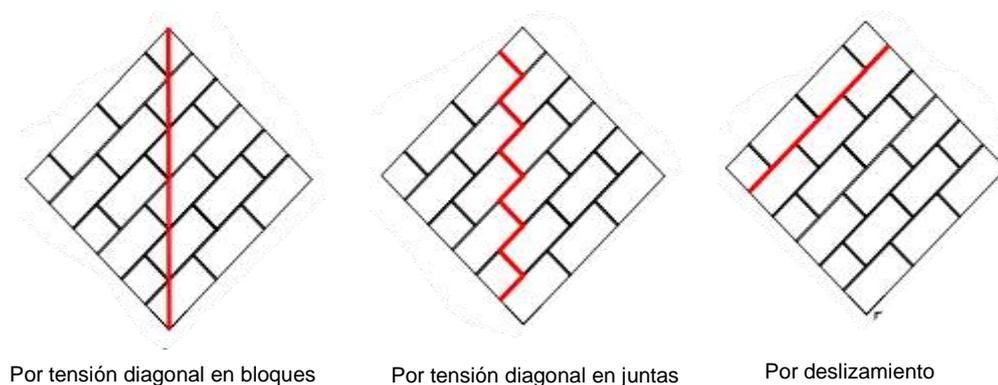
Fallas en un muro de albañilería simple sujeto a compresión diagonal [33].
